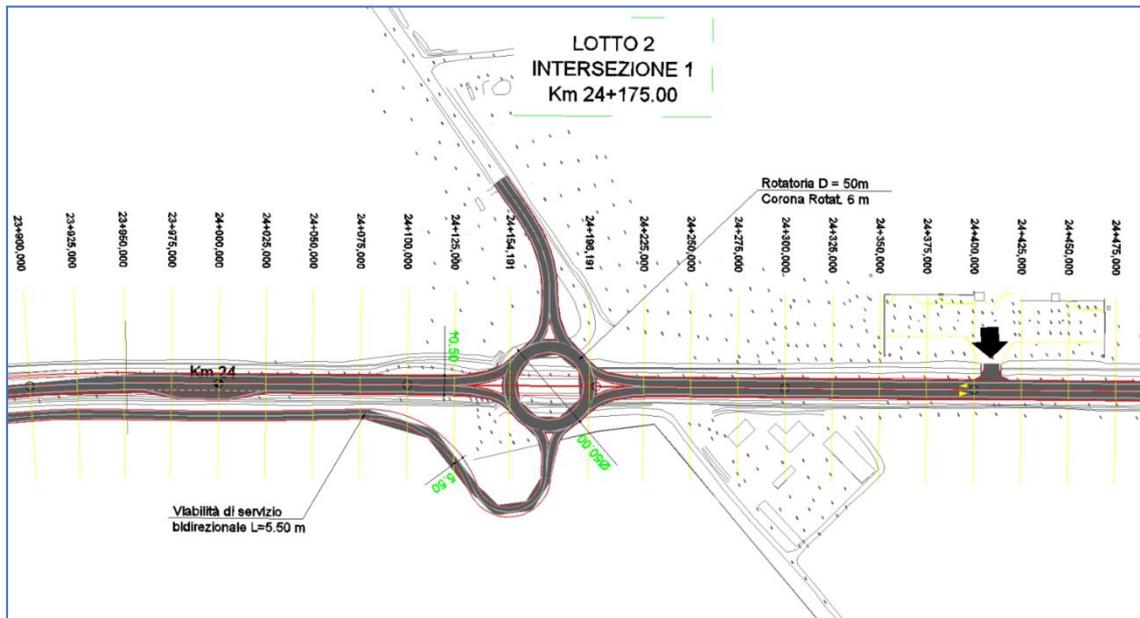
Intersezione 1 - Km 24+175 - Progetto
